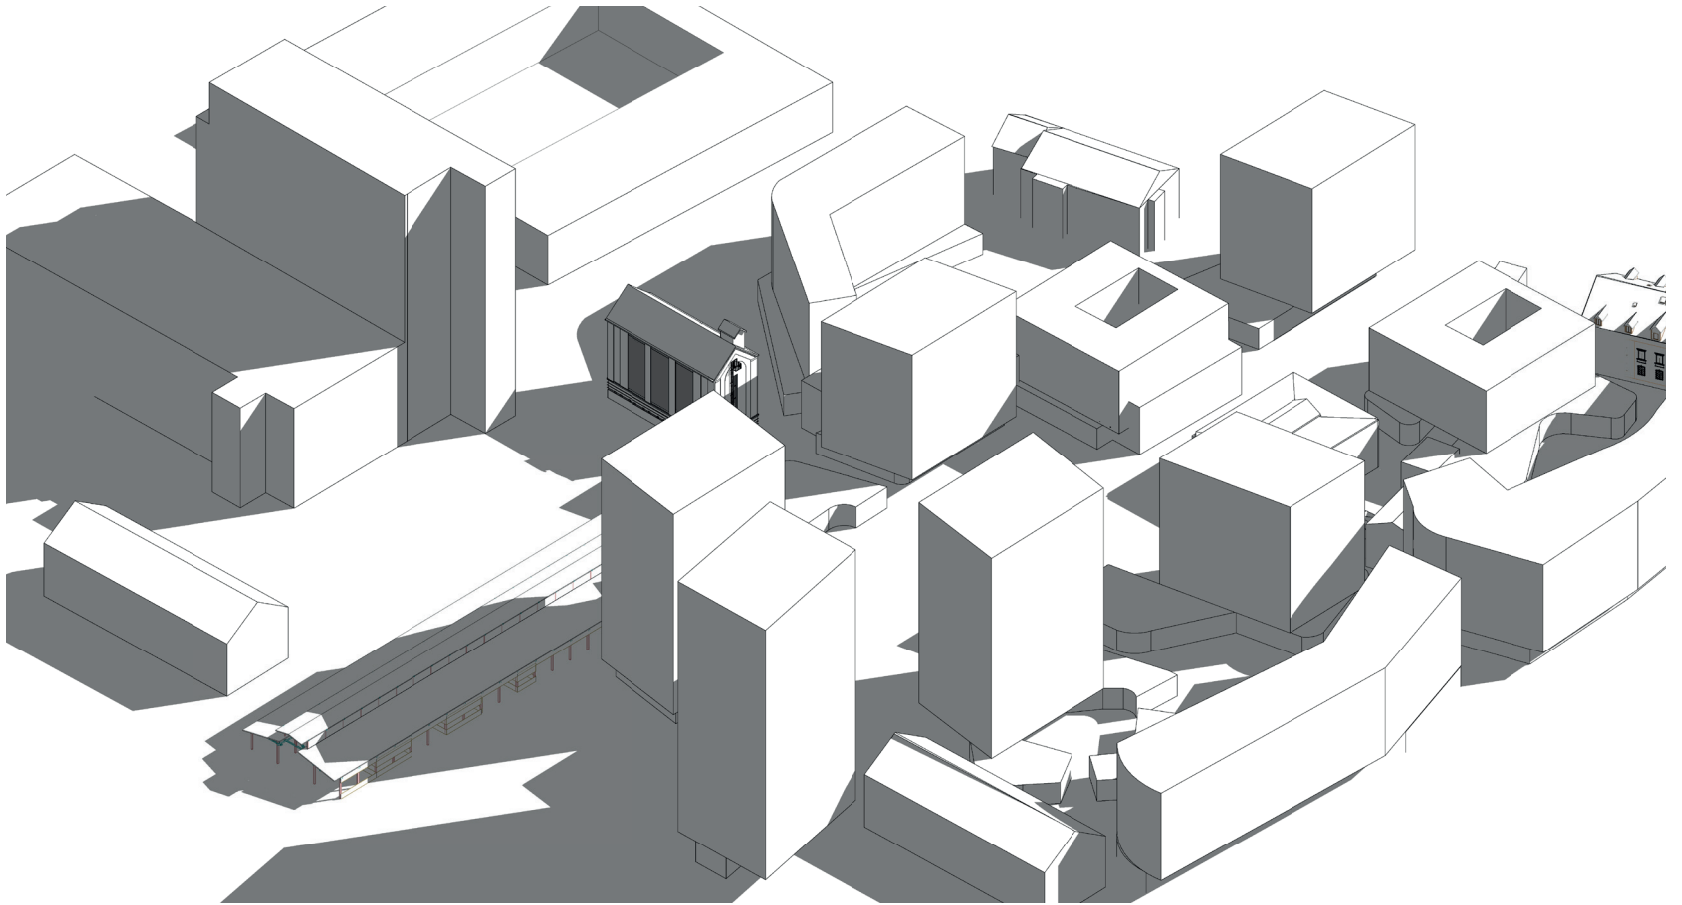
Lageplan axonometrisch Entwurf mit Bebauung Atelier Pucher
